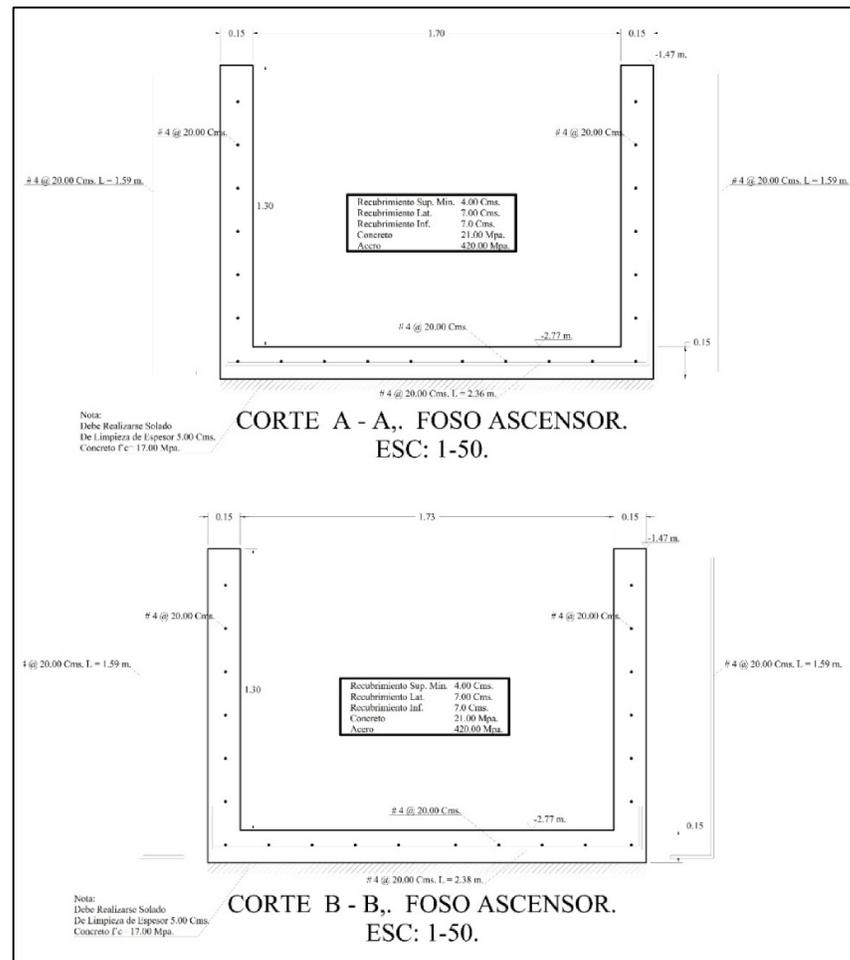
, Detalle Foso Elevador, Fuente: Constructora Open House.
